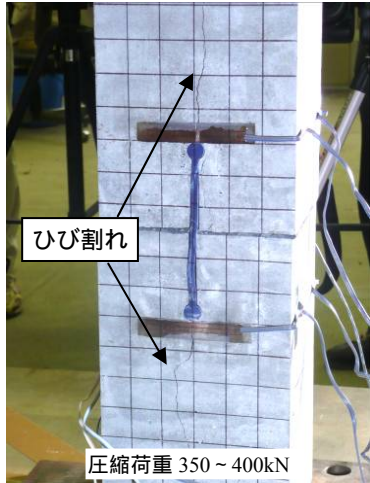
供試体 1 の載荷途中のひび割れ発生状況
